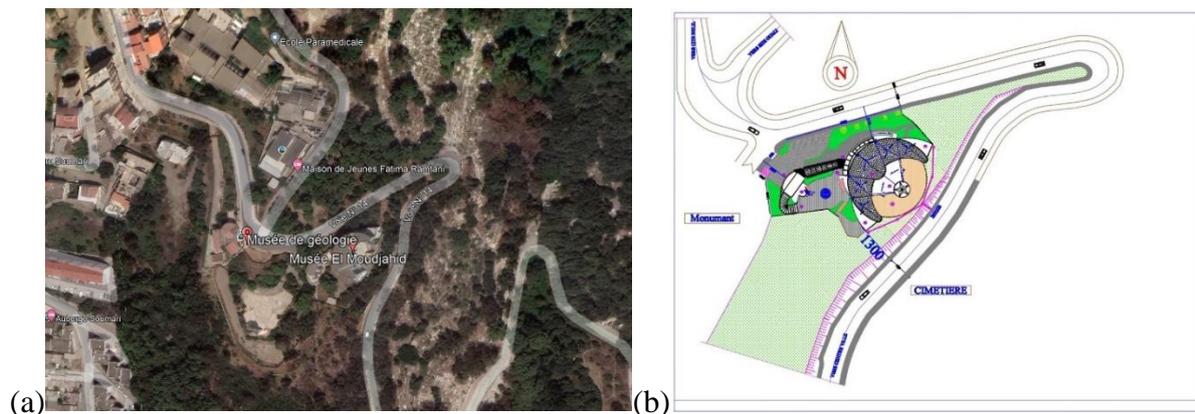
Plan de situation et plan de masse (Source : google earth, 2022)
